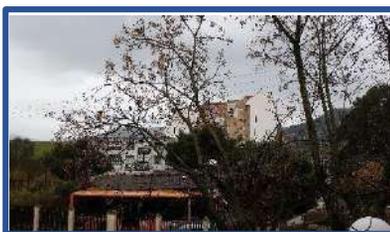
Immeuble collectif en construction au Nord, R+6
